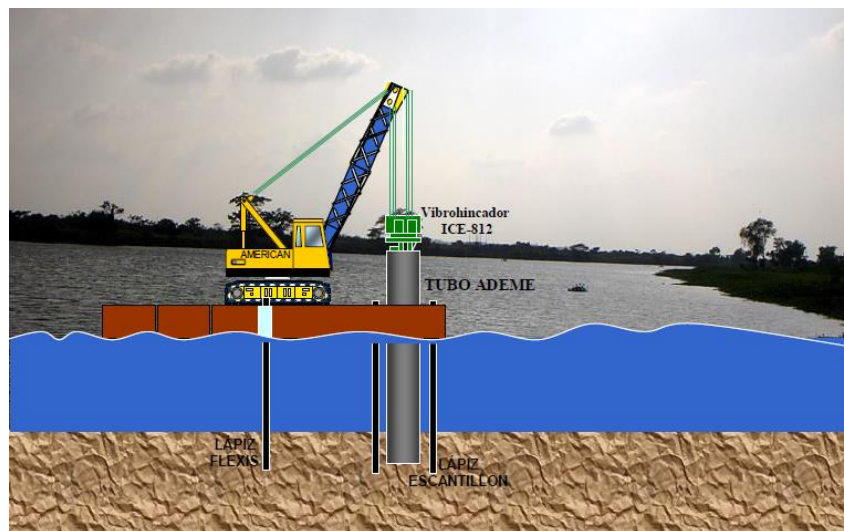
, Hincado de Pilote Mixto (Tubo de Acero y Concreto).
